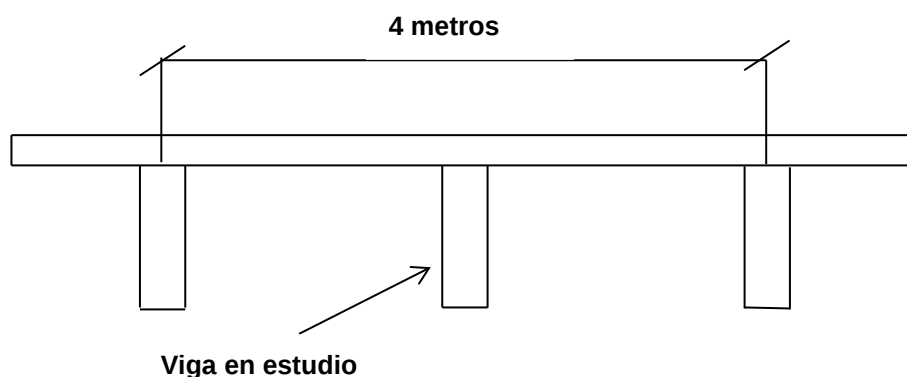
Ancho de la losa que se considera para el análisis de la carga viva sobre la viga.
